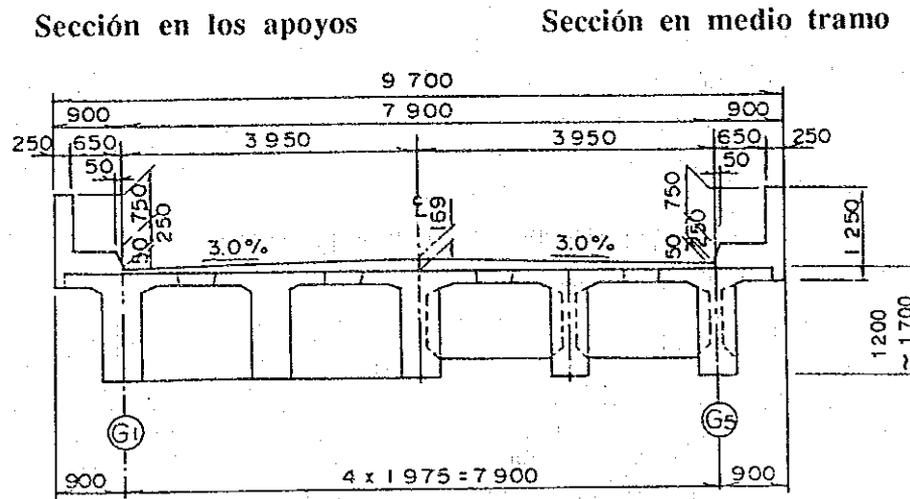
Sección de las vigas de sección "T" de concreto postensado
